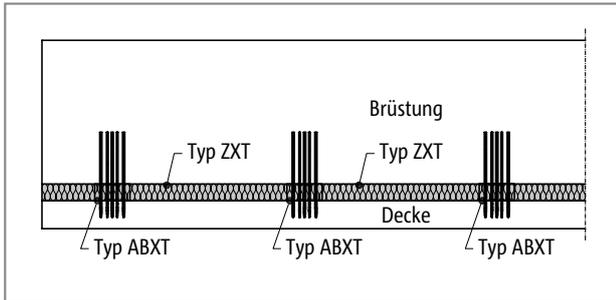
Schöck Isokorb® Typ ABXT vertikale Anordnung: Ansicht Brüstung aufgesetzt
